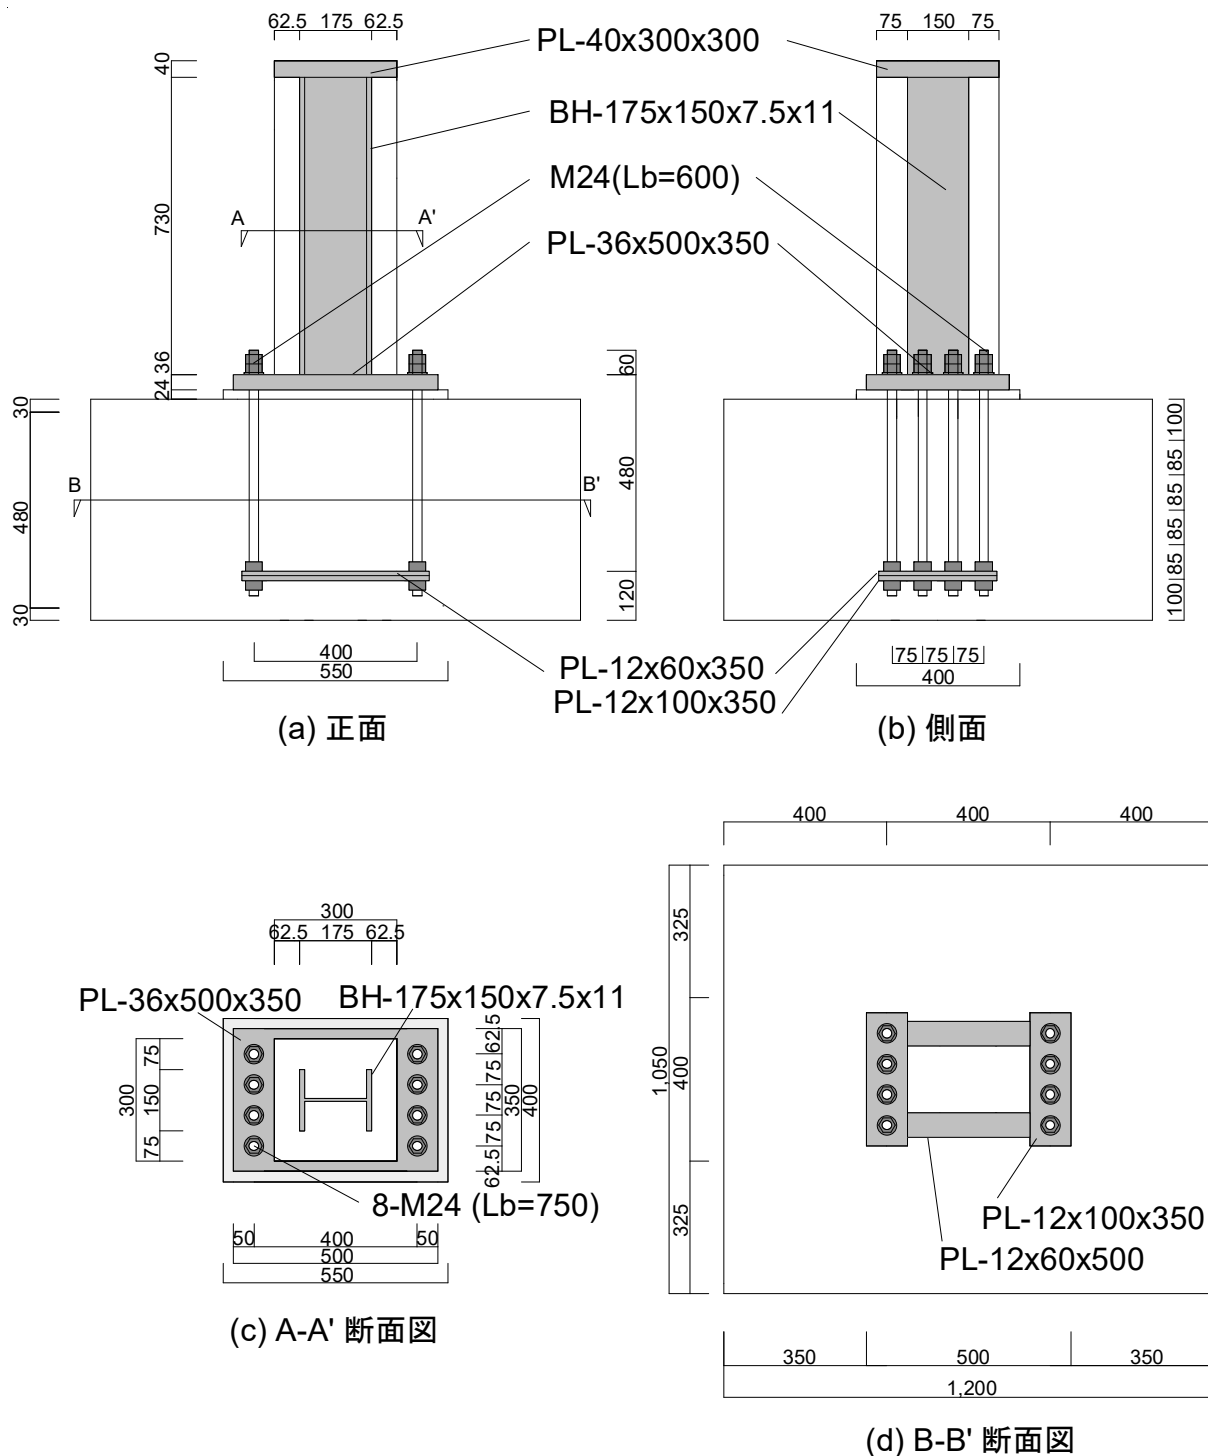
(c) 試験体鉄骨および AB 配置状況 (試験体 N500)
